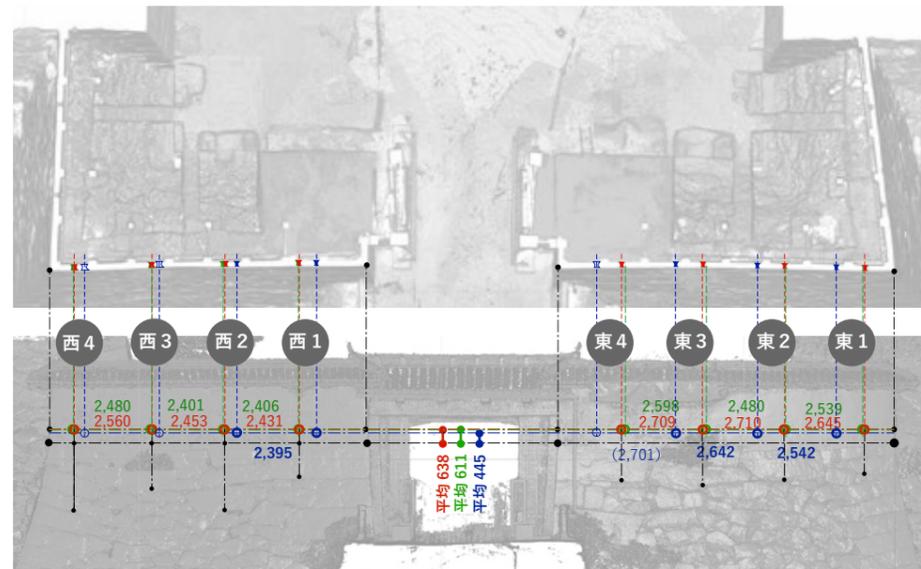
現況平面図・立面図（過年度およびR7測量結果より点群陰影図）
